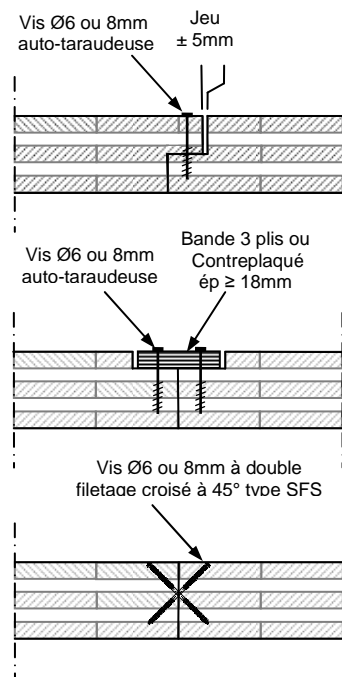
jonctions courantes entre panneaux de plancher ou de murs
